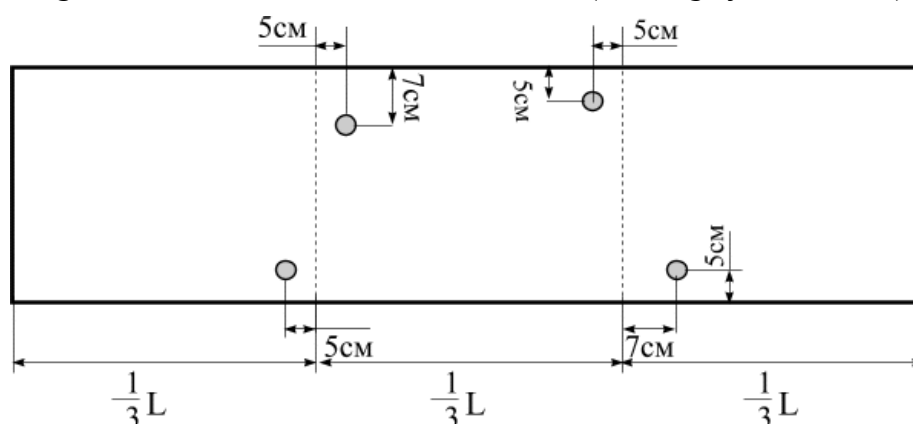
Схема расположения датчиков акустической эмиссии (рисунок авторов)
